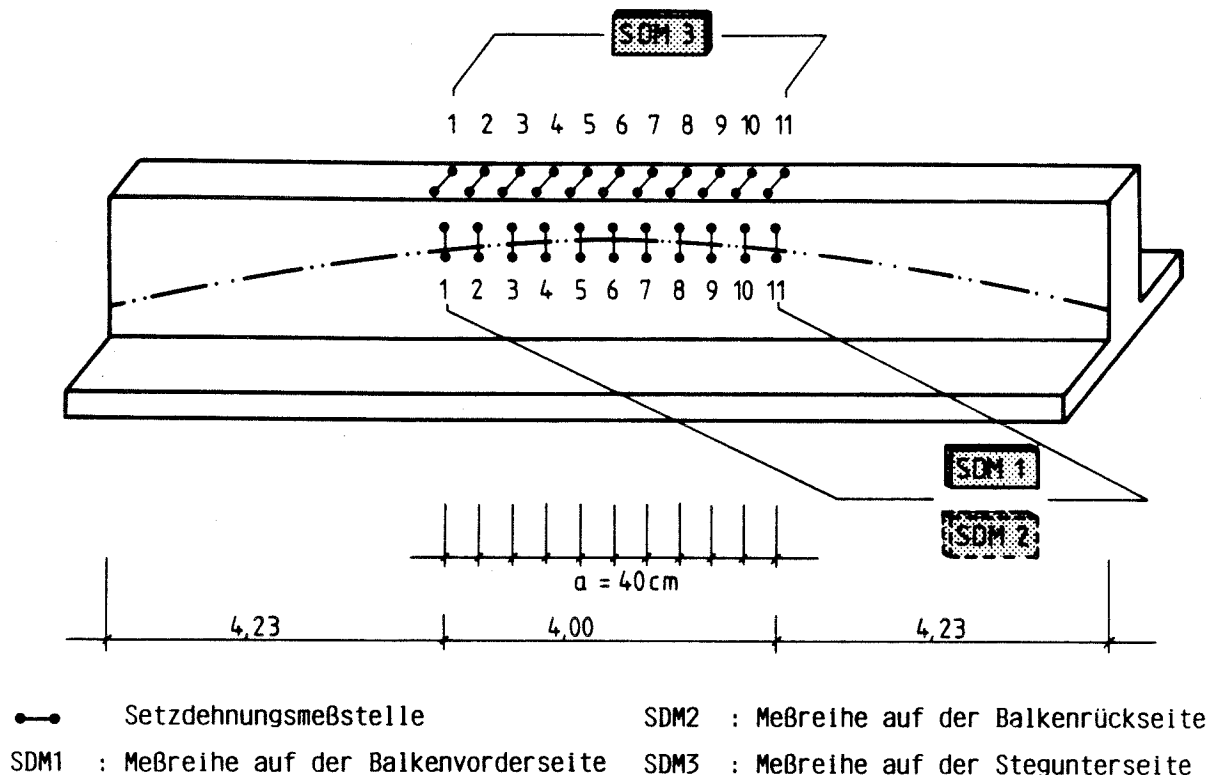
Erfassung der Betondehnung im Hüllrohrbereich
